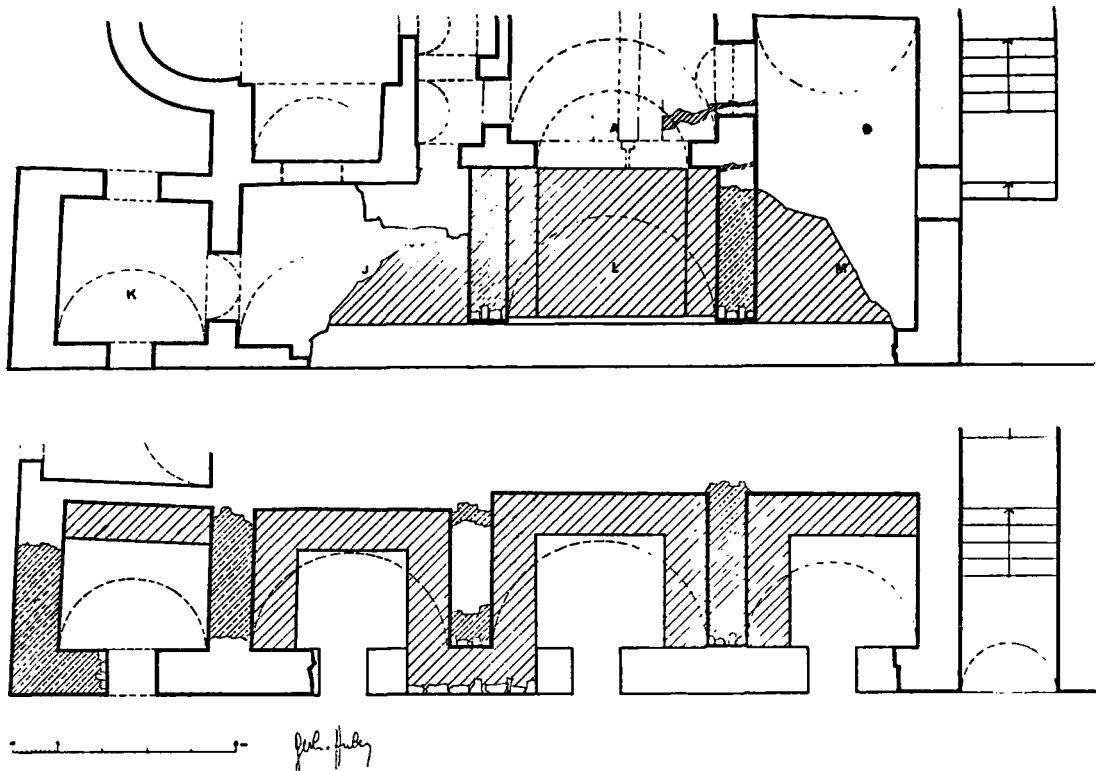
Hauptgeschossgrundriss; Untergeschossgrundriss des restaurierten Ostflügels.
